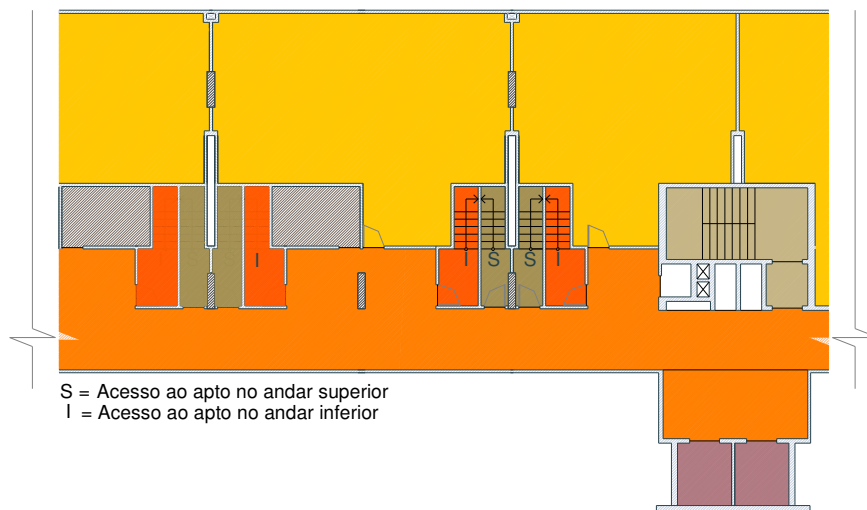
Planta baixa da unidade habitacional de circulação – Pavimento 3º, 6º e 9º
